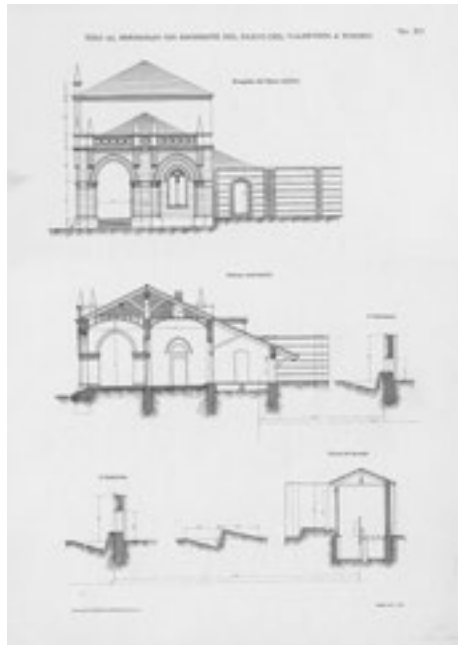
Tiro al Bersaglio già esistente nel Parco del Valentino a Torino. Prospetto del fianco sinistro e Sezione trasversale, con la tettoia dei bersagli (ASCT, Collezione Simeom, D 753, tav. XII).
